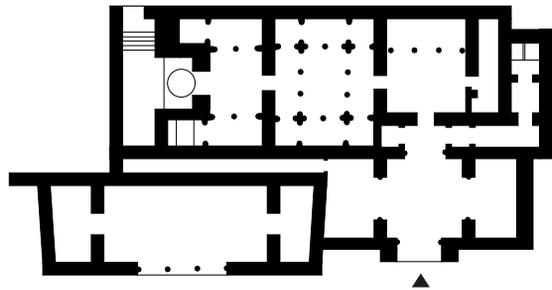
Grundriss Hammam Alcázar, Córdoba
